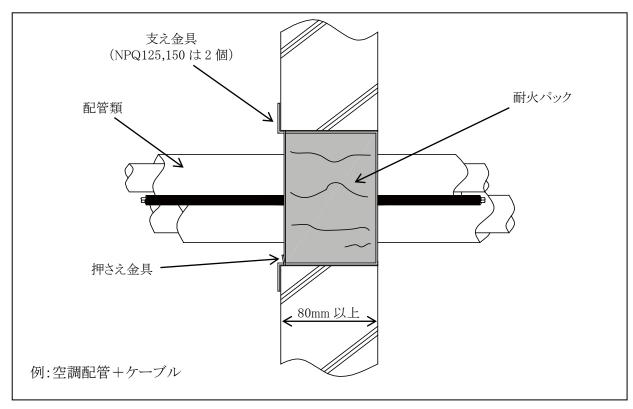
壁工法施工断面図:PS060WL-0862(ALC·RC 壁の場合)
